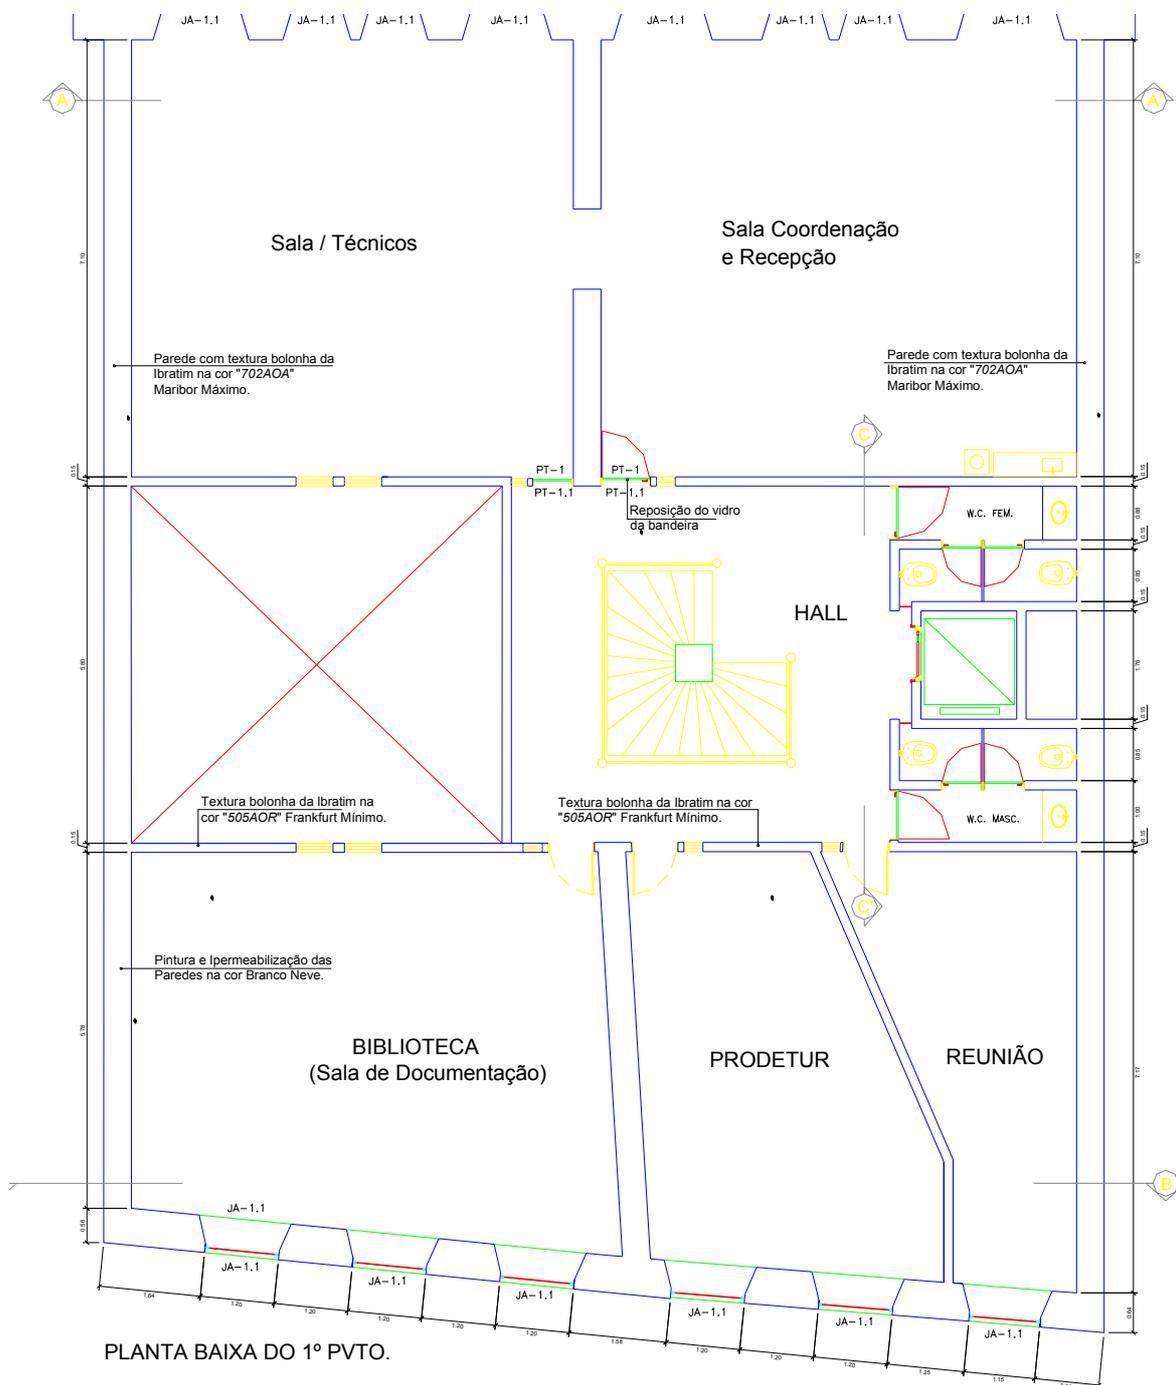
Planta baixa do 1º pavimento do imóvel da rua do Bom Jesus 227/237
